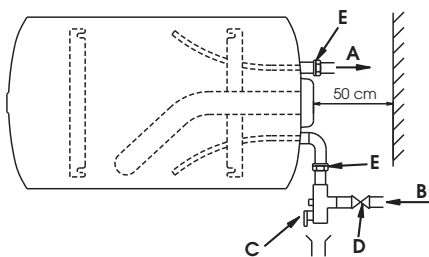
Modello orizzontale sull'elemento di protezione - tubi di alimentazione a destra
